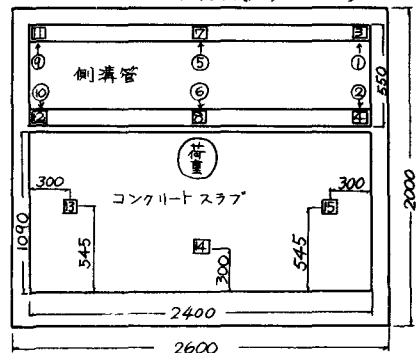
側溝管コンクリートスラブ、ダイヤルゲージ配置図
